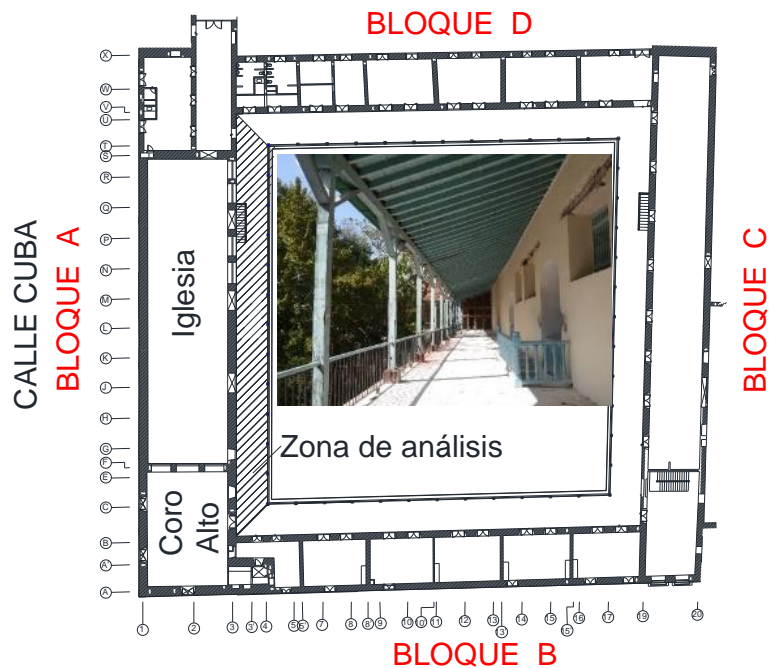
Croquis de planta del primer claustro, señalización y fotografía de la galería estudiada
